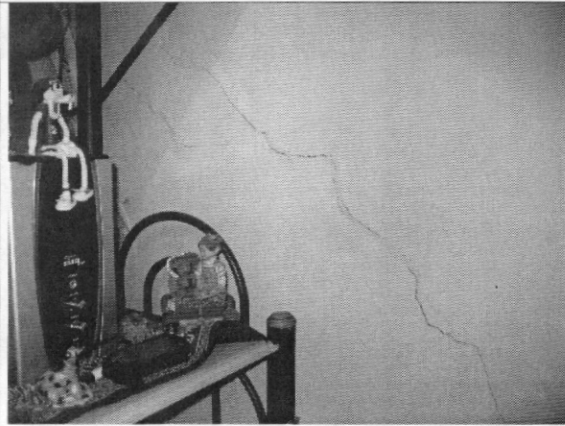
Grietas en muro suroccidental del sector posterior
